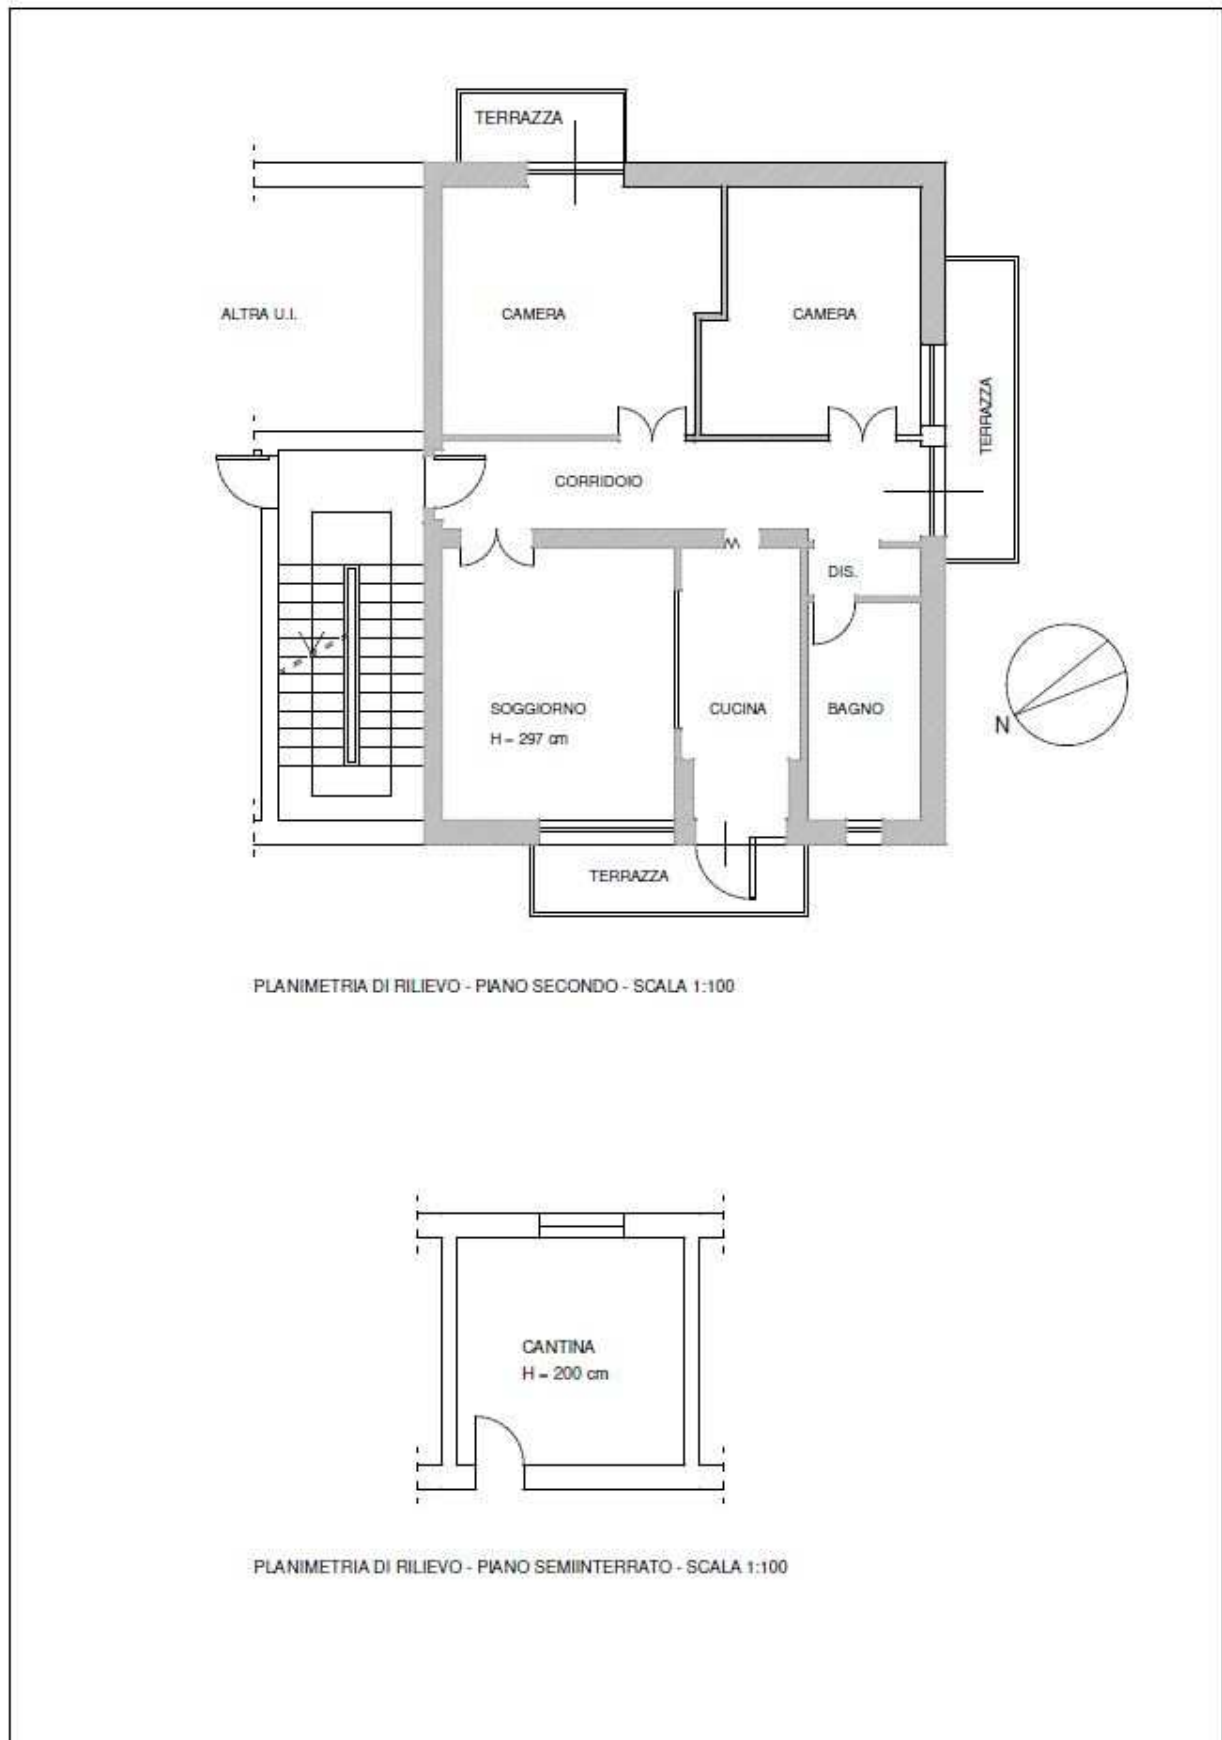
Planimetria immobile – da rilievo stato di fatto.
